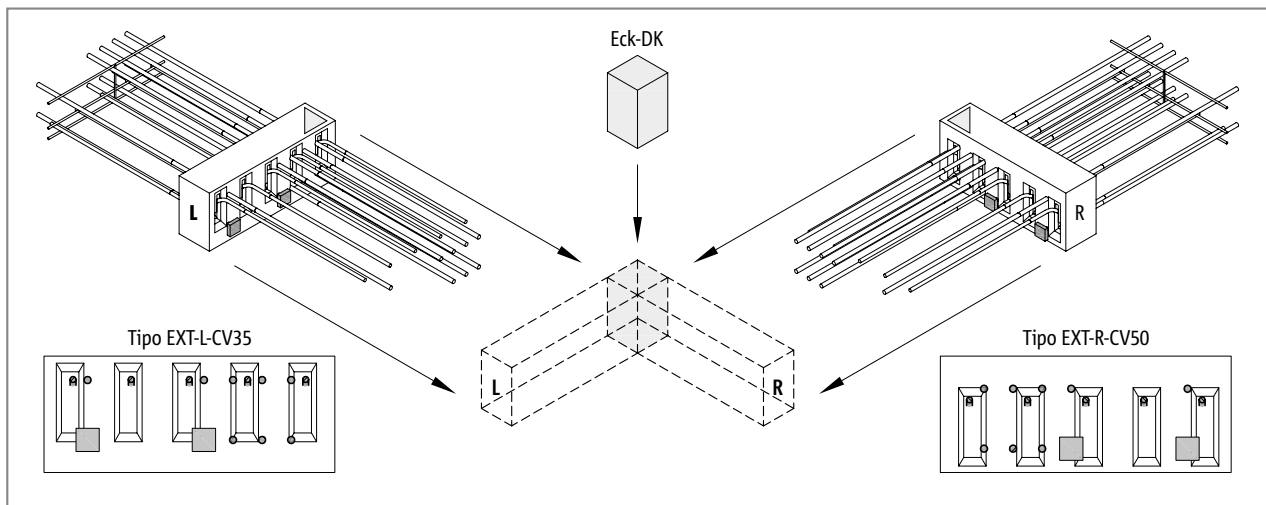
Schöck Isokorb® tipo EXT-L-CV35, EXT-R-CV50: disposizione sull'angolo con il materiale isolante ad angolo
